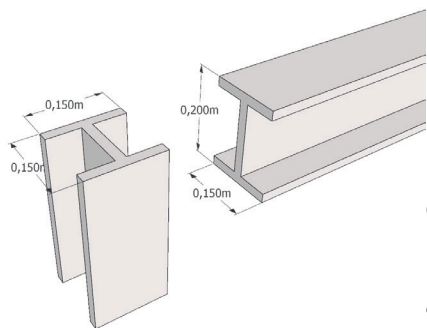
Pilar e vigas utilizados na escola. Fonte: Elaborado pelo autor.
